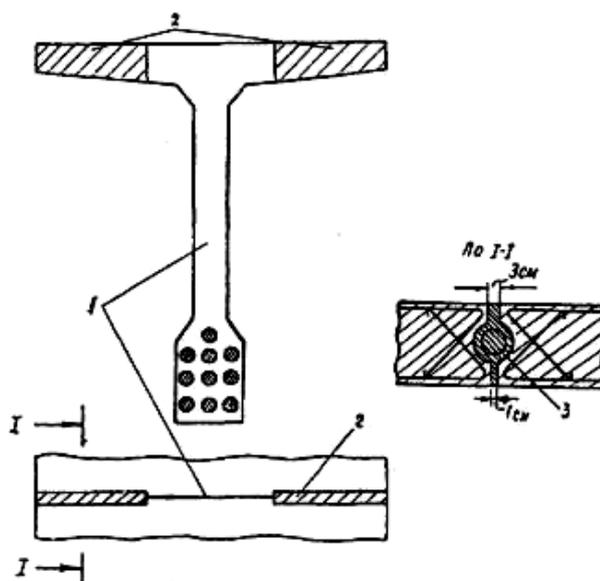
Схема устройства комбинированного стыка: 1-сухой или клееный стык; 2-бетонируемые стыки с железобетонной шпонкой; 3-стальная спираль
